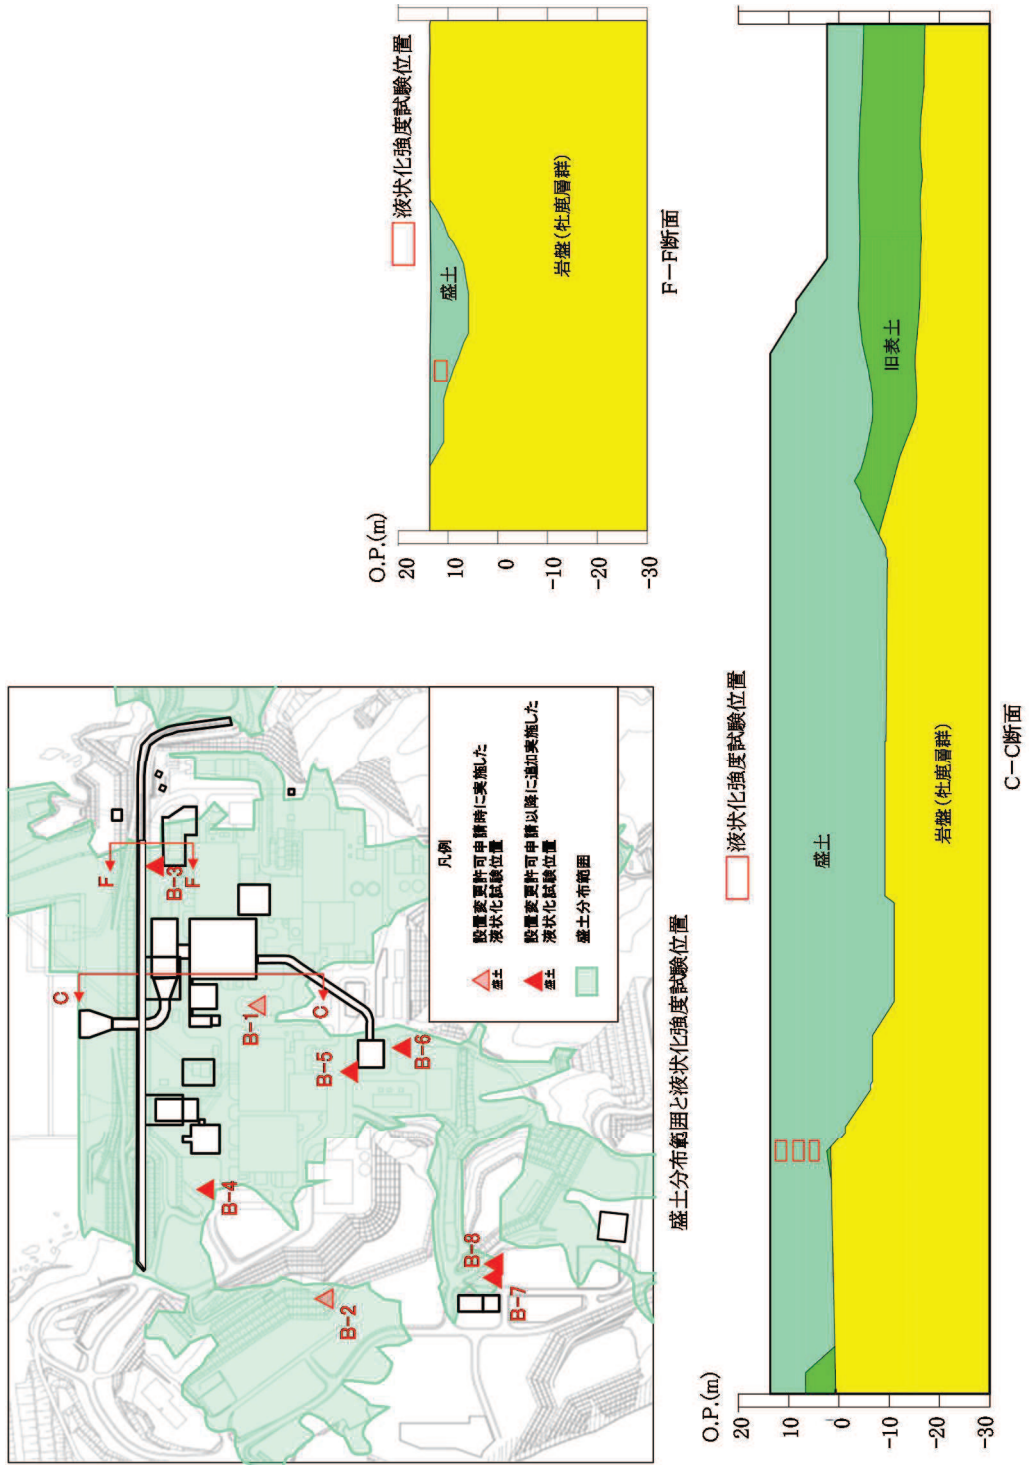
(1) 盛土の液状化強度試験に用いる試料採取位置断面図(1/3)
